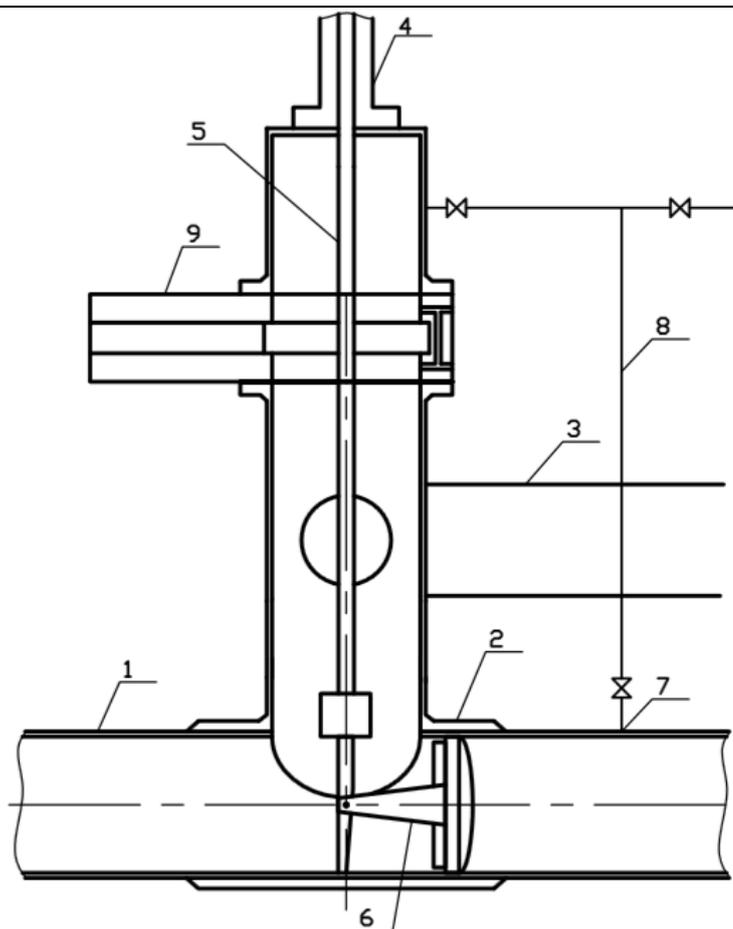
Схема монтажа механизма STOPPLE для перекрытия
